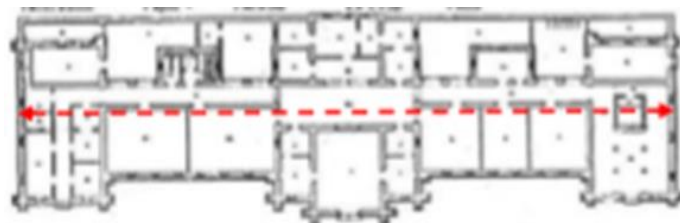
Plano de la fachada principal del Hospital Noble. (WorkHouses, s.f.)
